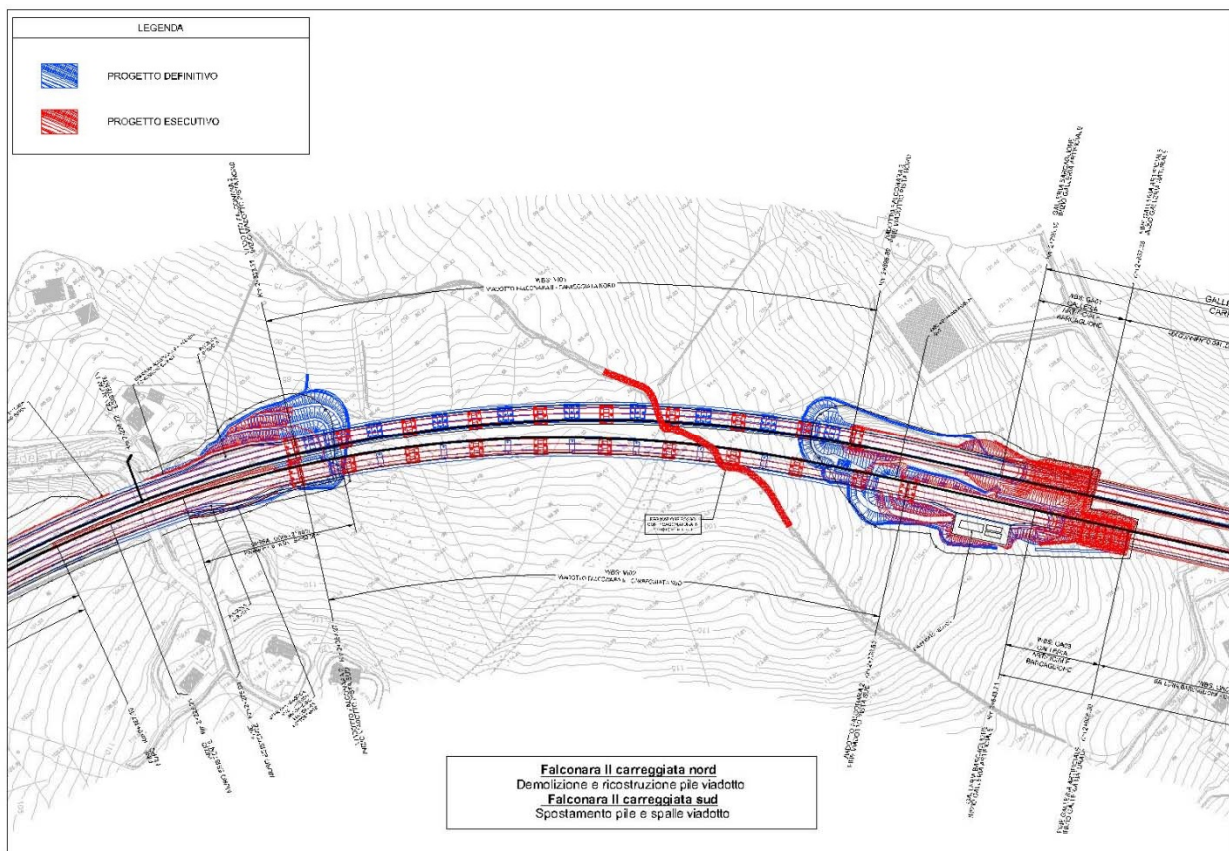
Sovrapposto planimetrico tra PD e PE nella zona Intervento 2
